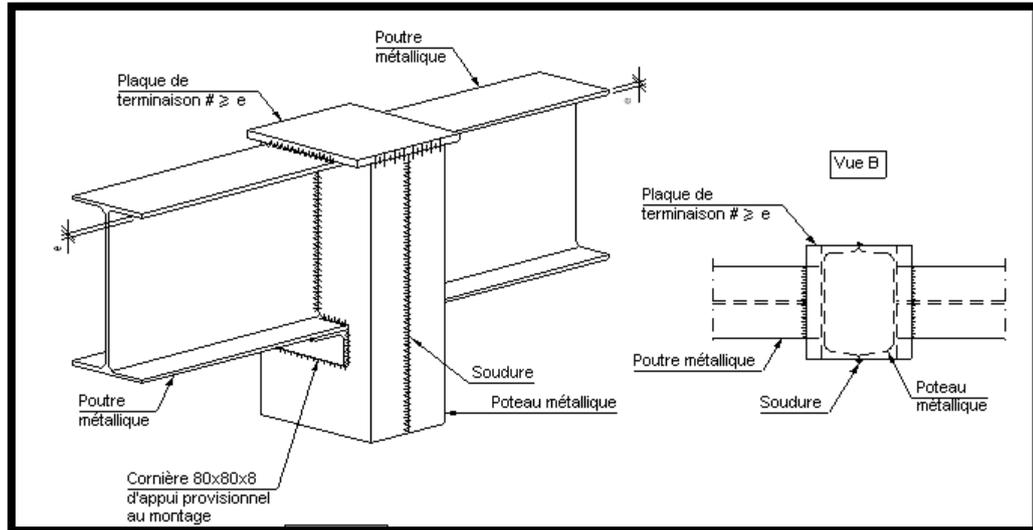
Détail de jonction Poteau, Poutre, plancher.
